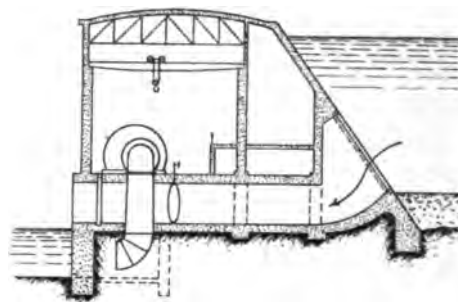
Turbinenanlage im Anschluß an ein hohles Wehr.
